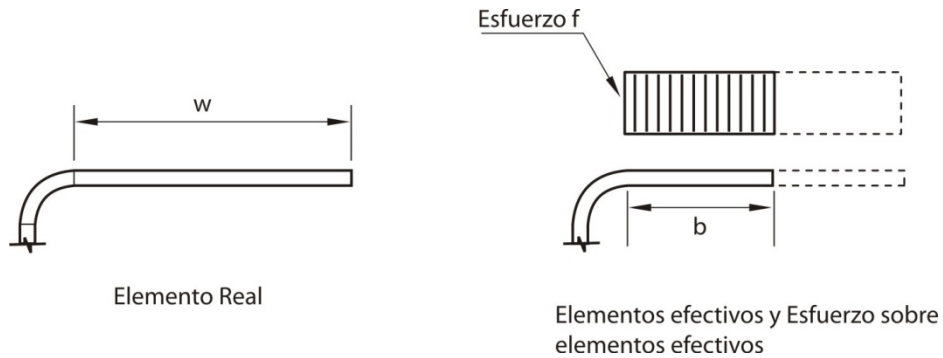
Elemento no rigidizado bajo compresión uniforme
